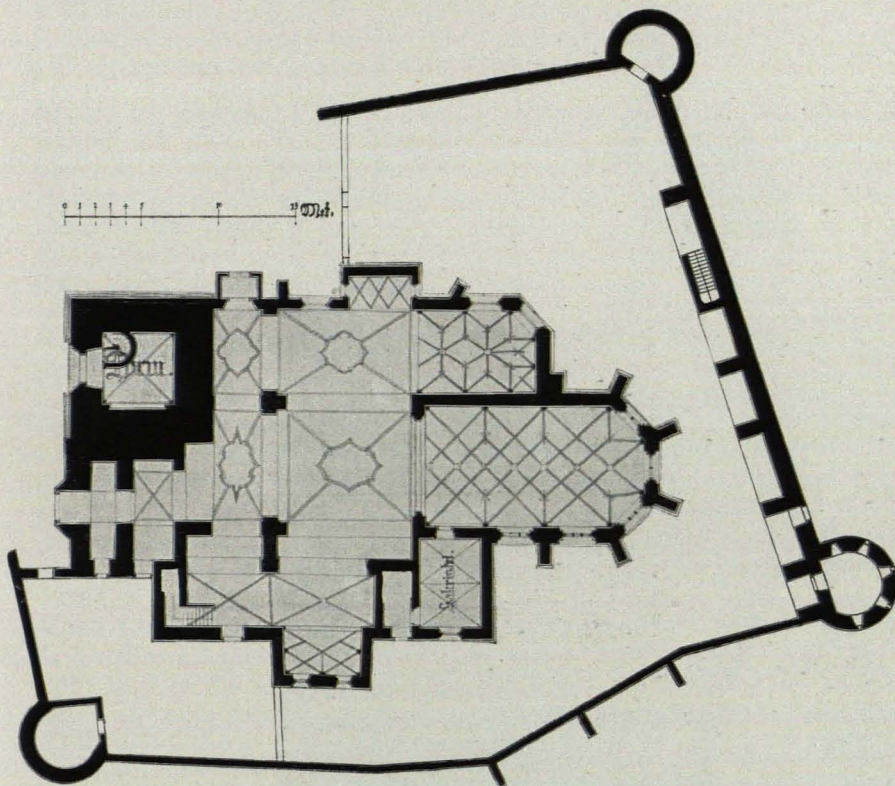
Weißkirchen, Pfarrkirche, Grundriß 1 : 500 (S. 554)
